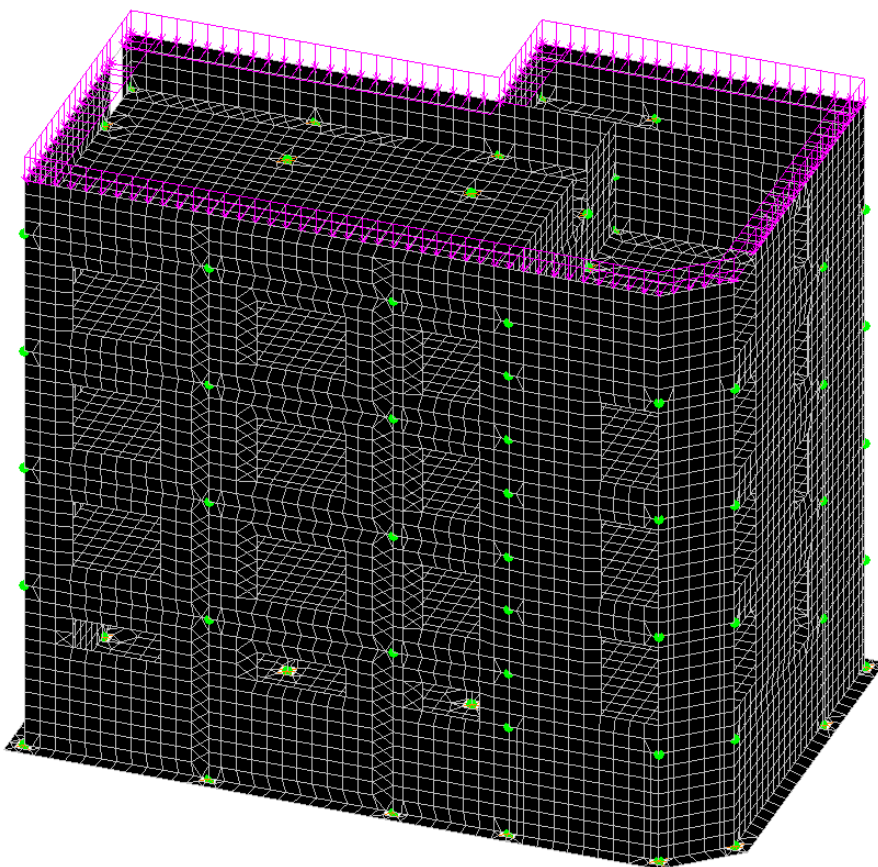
Схема приложения нагрузок от мансарды
